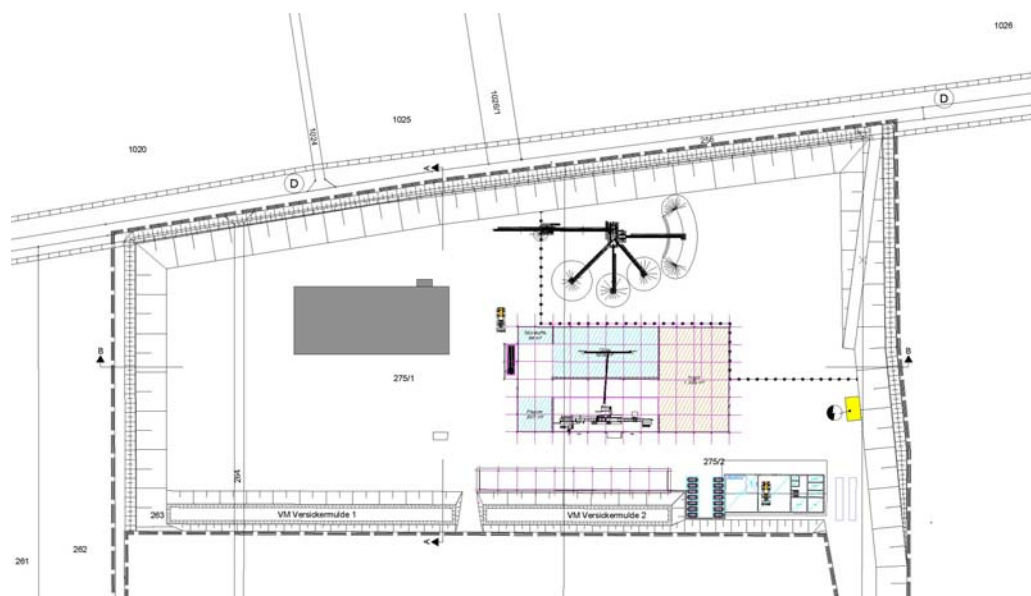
Darstellung des Betriebsgeländes mit der möglichen Lage der geplanten Anlagen, Planungsstand vom 15.07.2025, (Änderungen vorbehalten) (o. M.)
